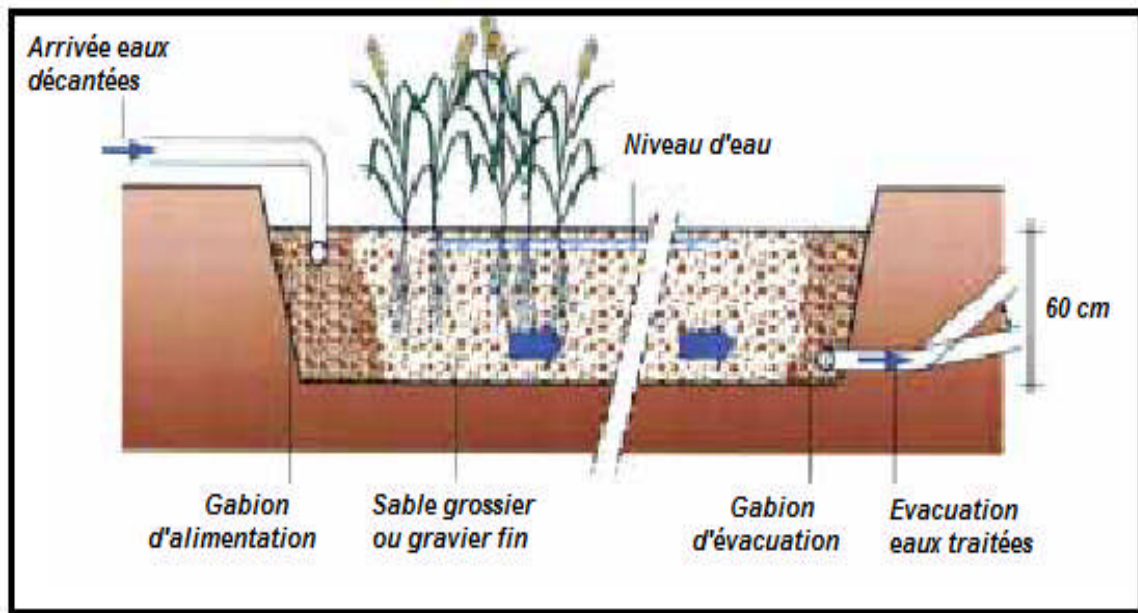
Coupe transversale d'un filtre planté à écoulement horizontal
